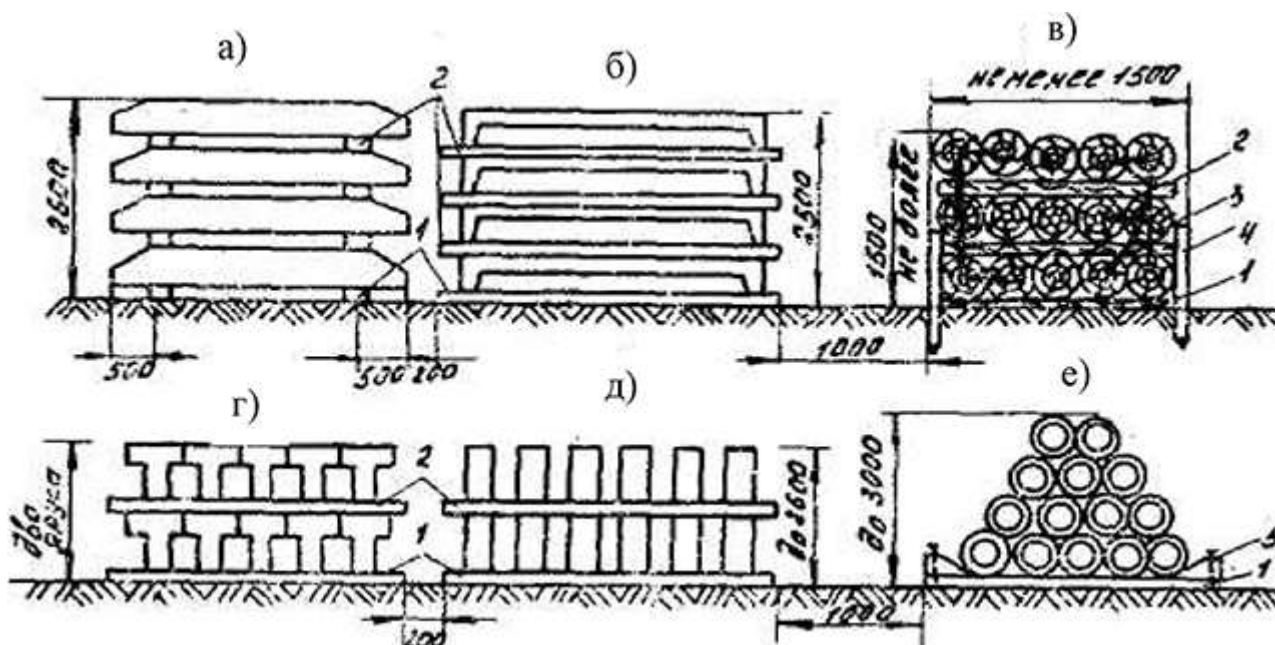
Способы складирования материалов и конструкций: а - фундаментные блоки; б - плиты покрытий и перекрытий; в - круглый лес; г - подкрановые балки; д - прогоны, колонны; е - трубы; 1- подкладки, 2 - прокладки. 3 - скобы, 4- упоры, 5 - подкосы
